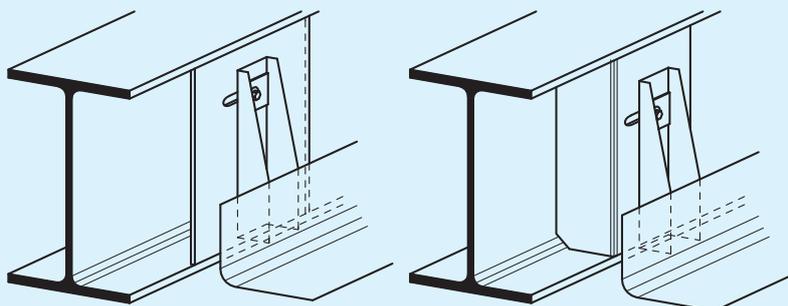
Типовая деталь крепления к стальным элементам
